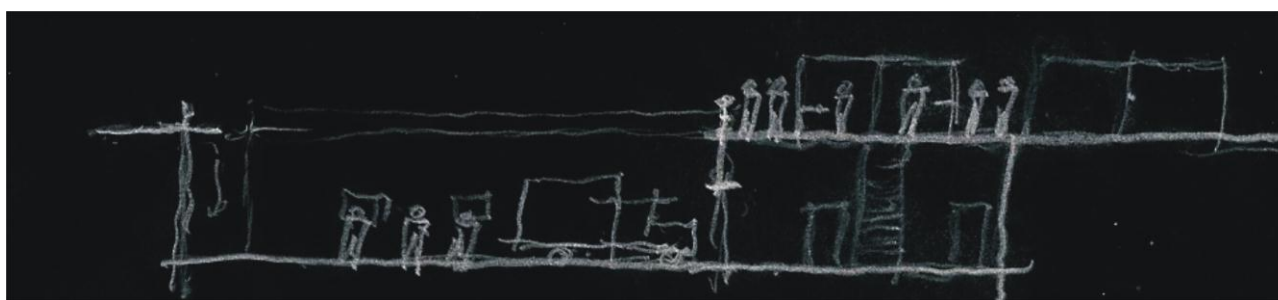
Croqui inicial de concepção da área de carga e descarga.
